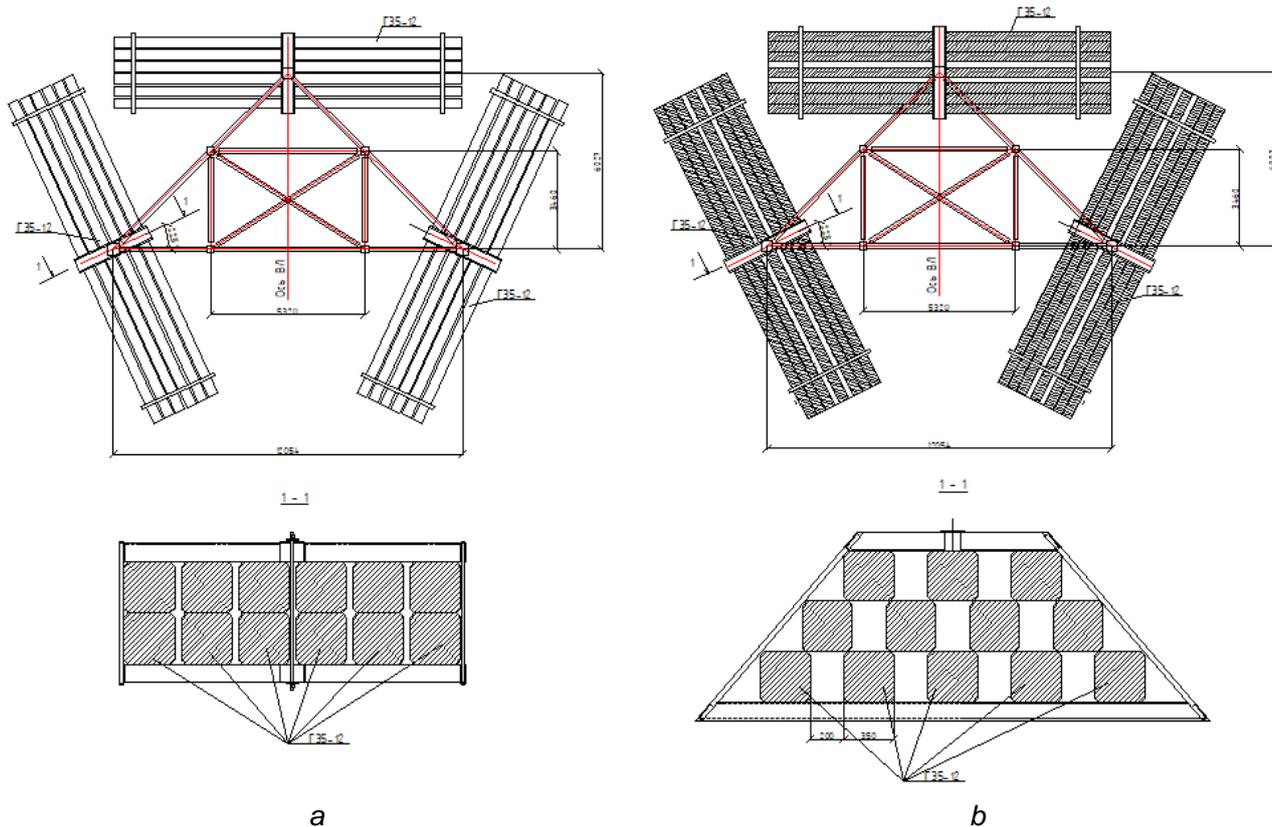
Поверхностный фундамент: а – с обычным расположением железобетонных грузовых балок; б – из железобетонных грузовых балок с увеличением площади опирания (с рациональным расположением балок)
